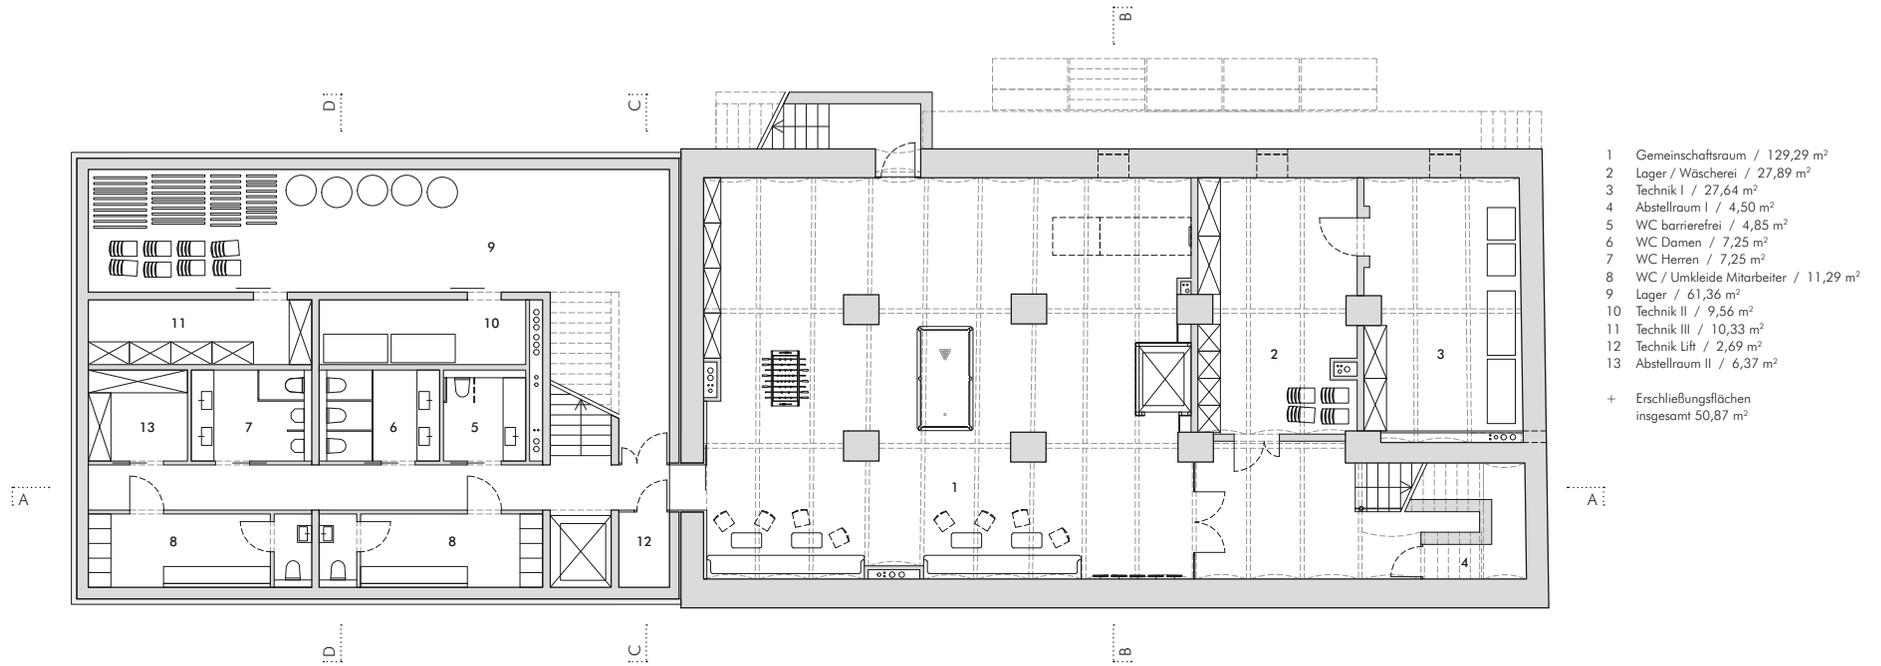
Grundriss Kellergeschoß, Entwurf, M 1:200
